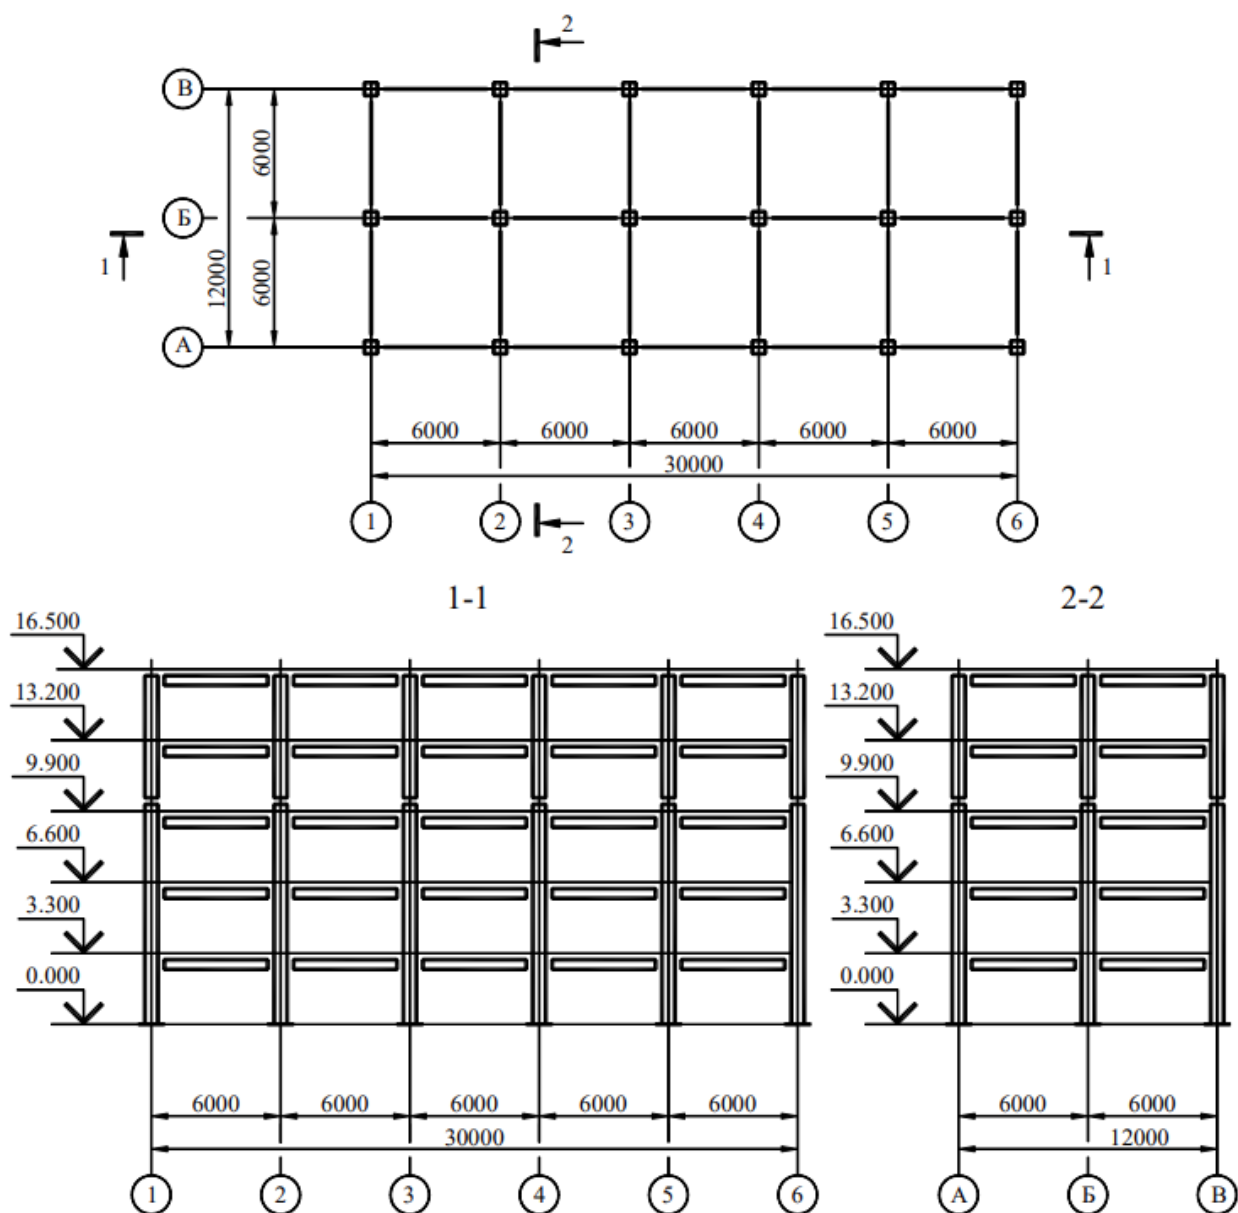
Схематический план и разрезы каркаса здания.
